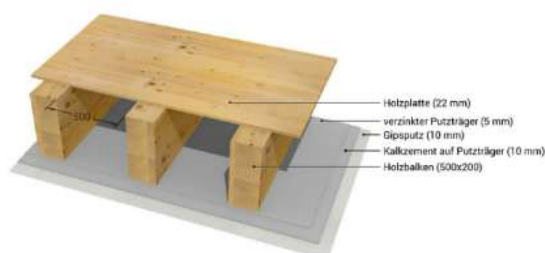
Exemplarischer Aufbau Decke Obergeschoss/Dachgeschoss
